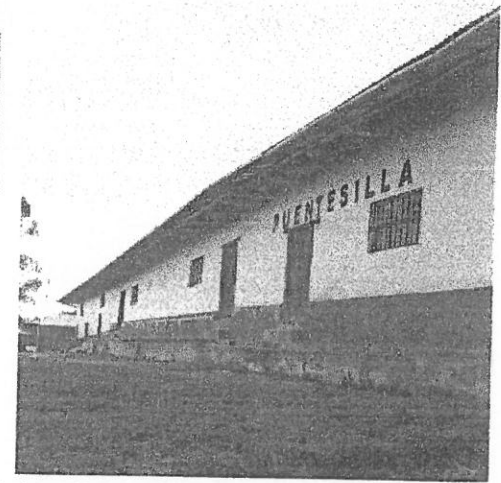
Estructura de tapial y techo de madera y calamina.
